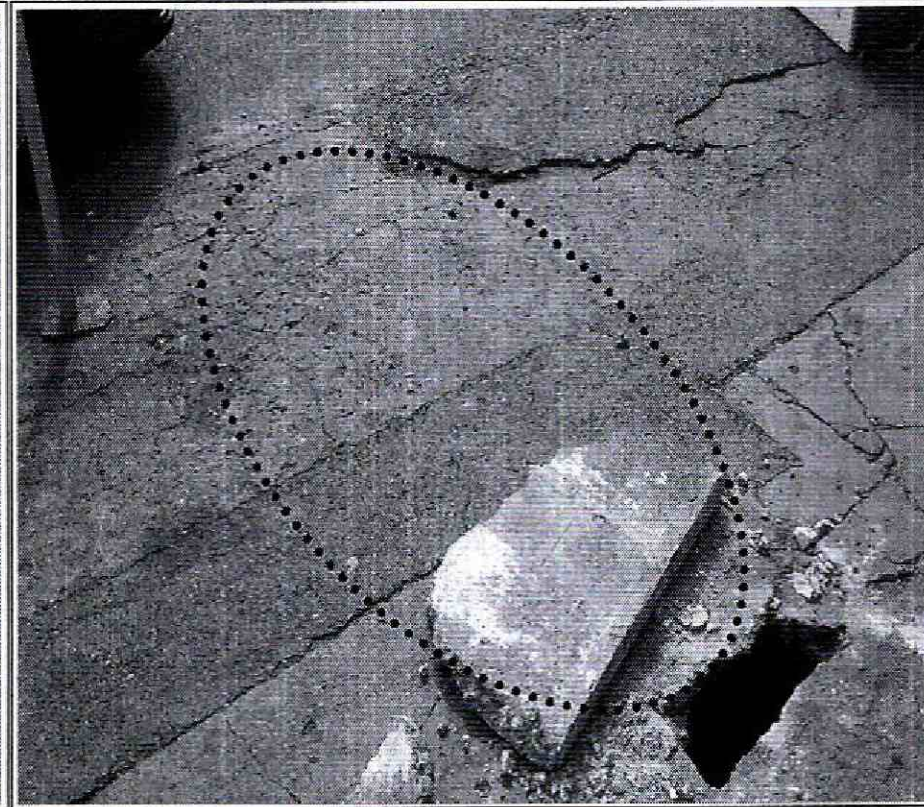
Avance de la socavación de la estructura de cimentación del andén
